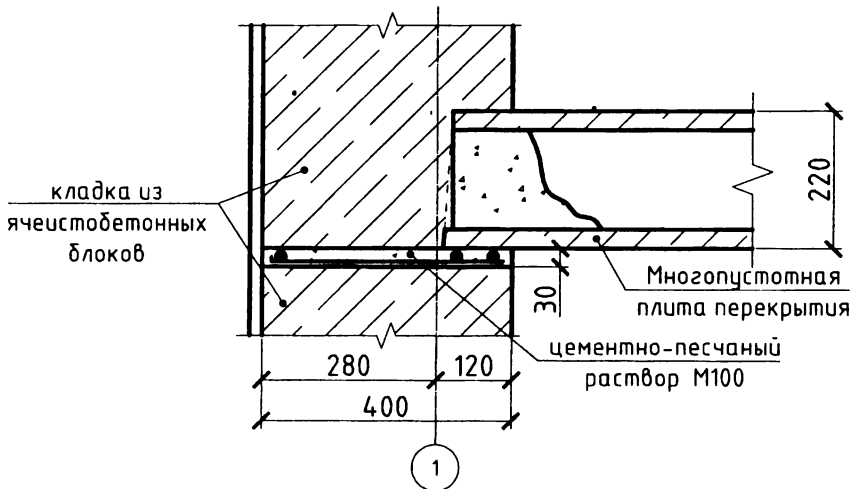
Опирание пустотных плит перекрытий на несущие стены из мелких блоков по слою цементного раствора
